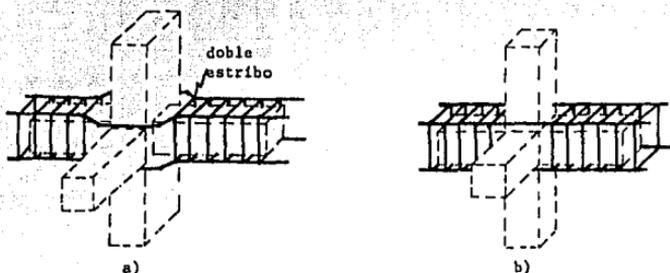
Detalle de la continuidad del acero de la viga encamisada.
